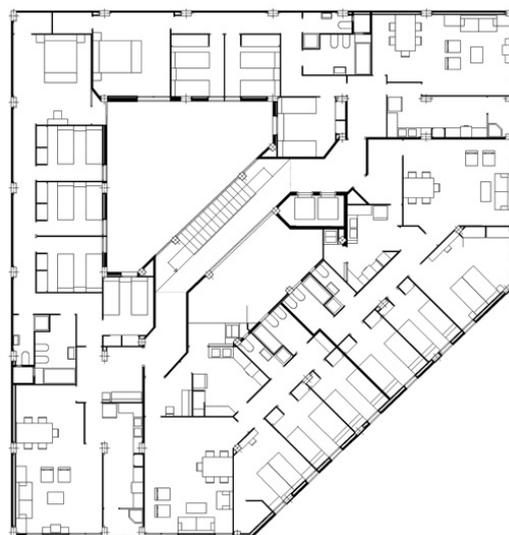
Planta tipo del Edificio de viviendas en la calle Artes Gráficas. Fuente: COACV
